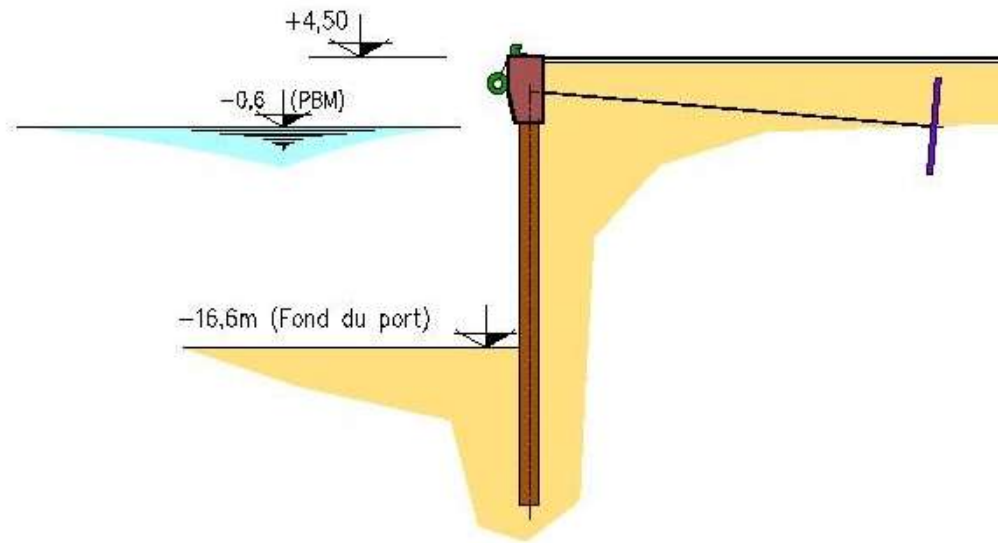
Paroi moulée avec ancrage horizontal – Coupe transversale
